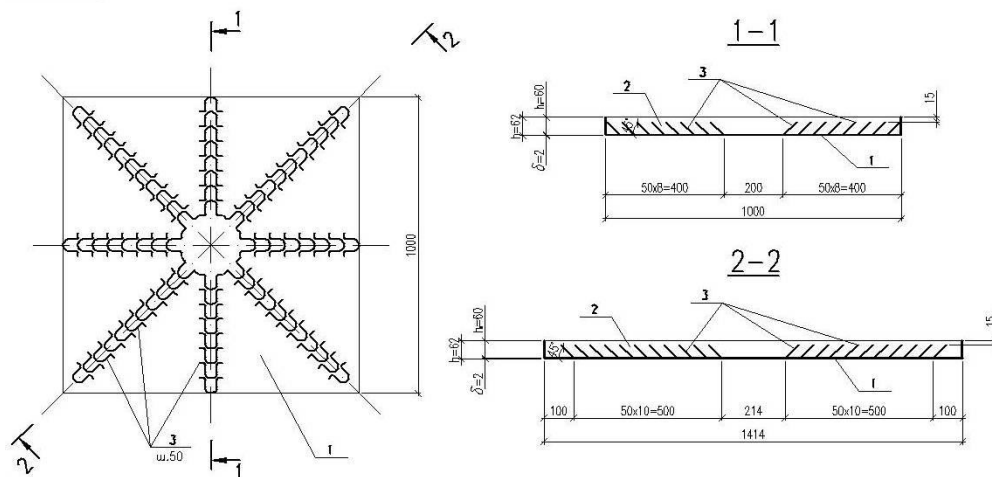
Конструкція сталобетонних плит П-3, П-4, П-7, П-8:
